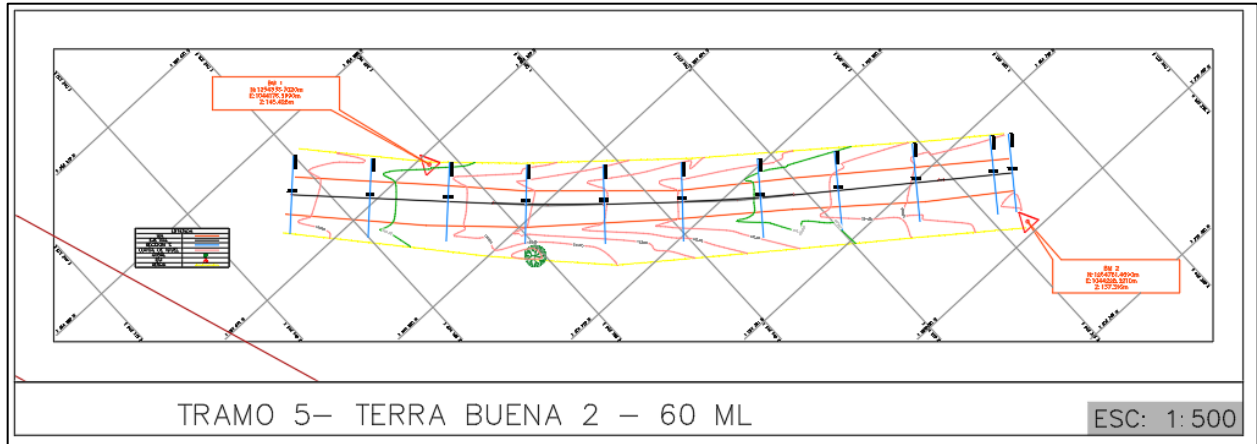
Imagen de planta del tramo 5 del proyecto de San Vicente de Chucuri-Santander
